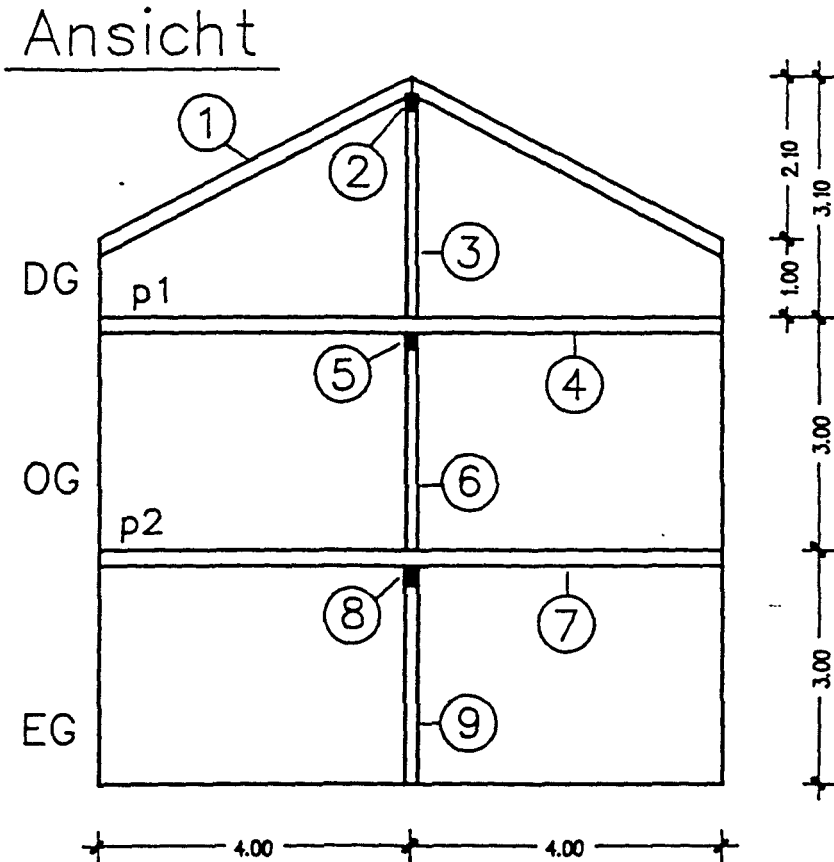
Querschnitt des 2stöckigen Wohnhauses aus [3/23]
